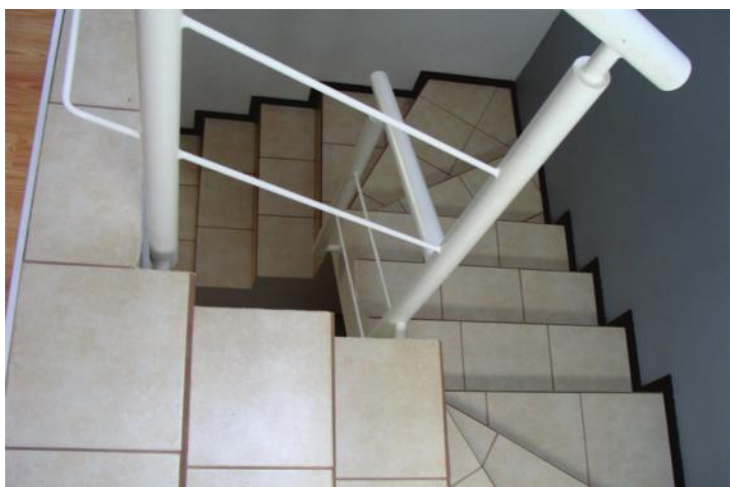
FOTO DE ESCALERA TERMINADA (SAUCE).
